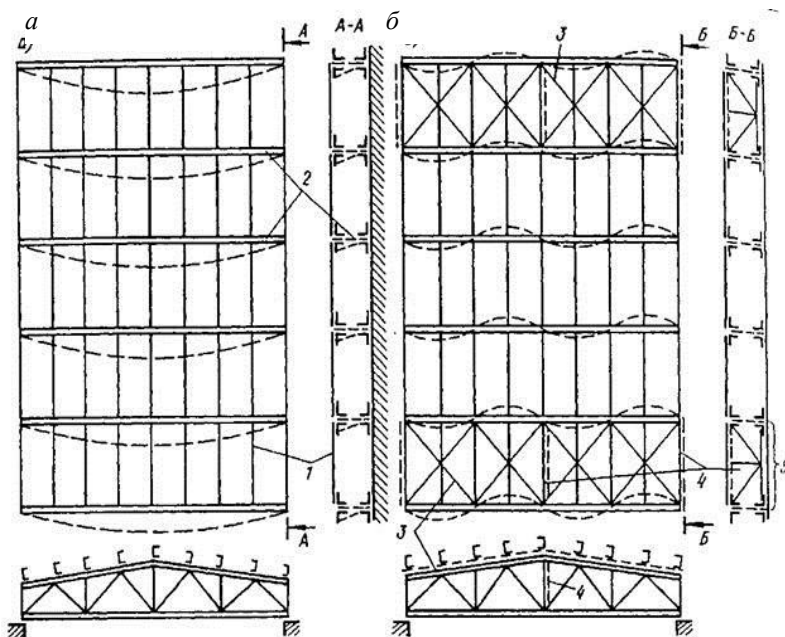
Связи обеспечивающие устойчивость стропильных ферм::
